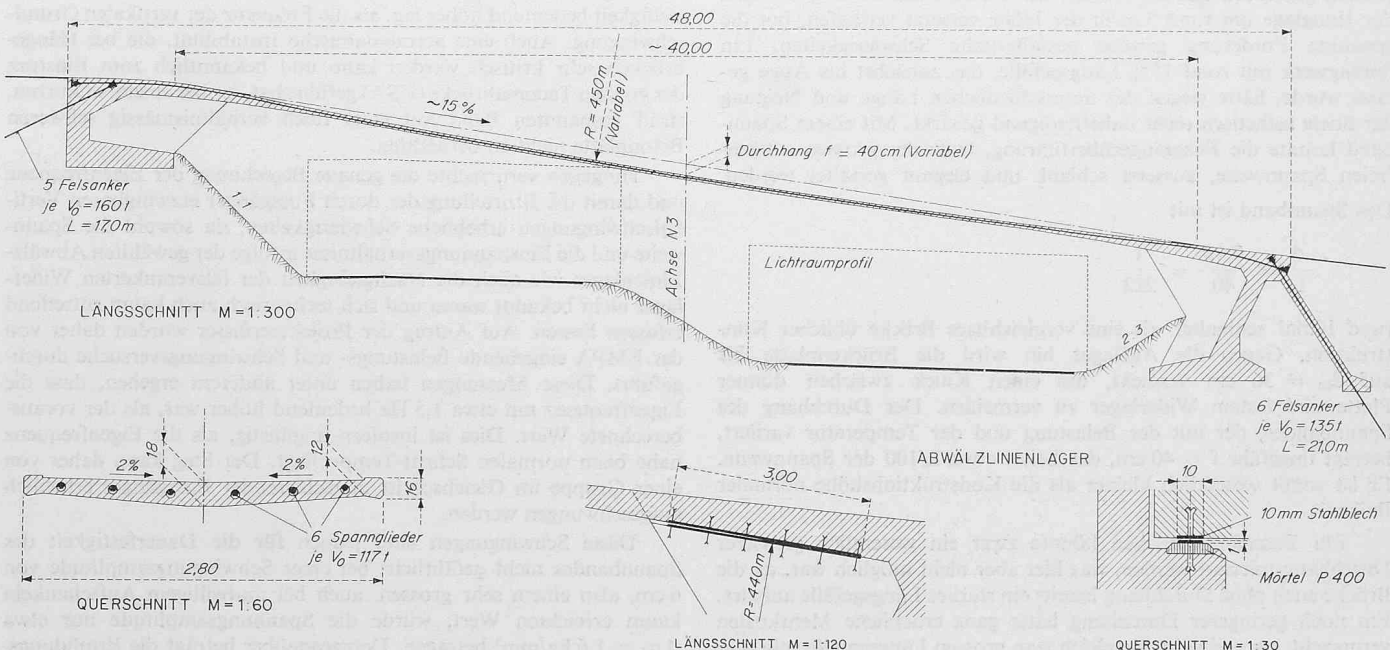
Längsschnitt und Konstruktionsdetails des Spannbandes Bircherweid
